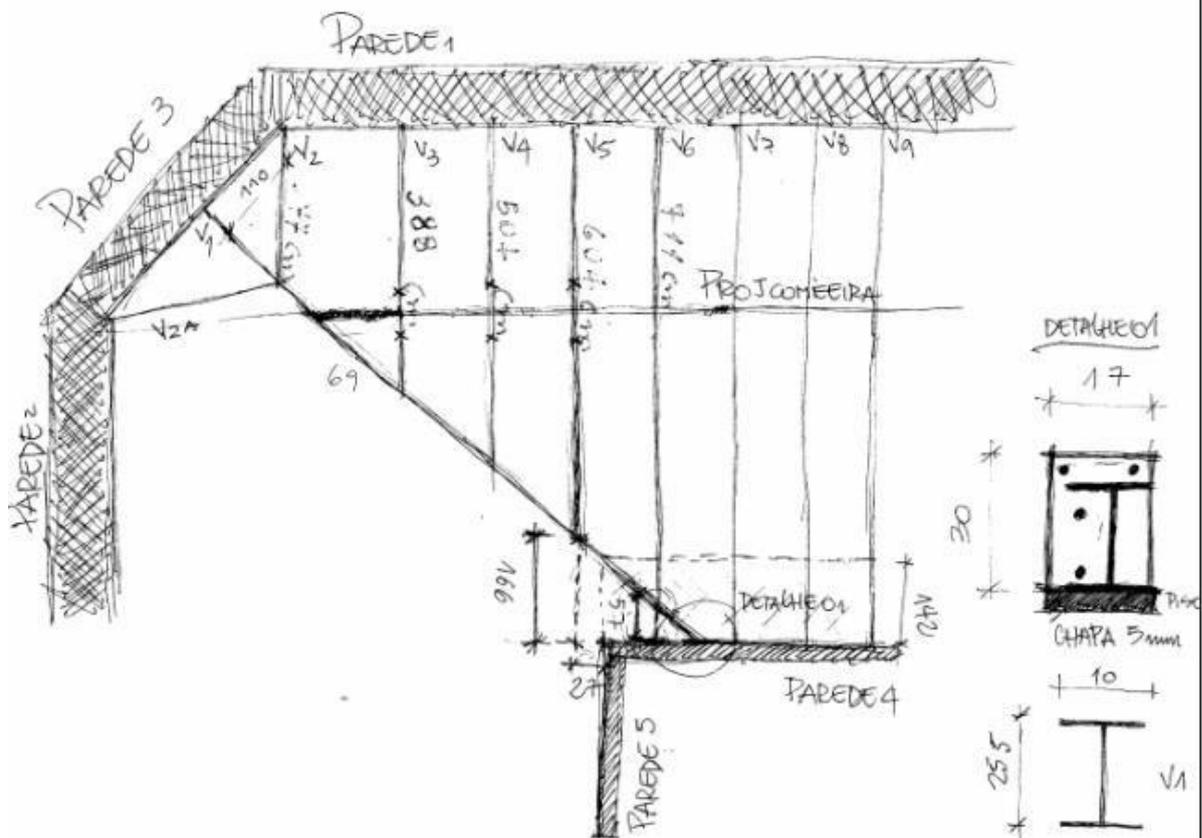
Detalhamento dos pontos a serem reforçados por processo de soldagem
